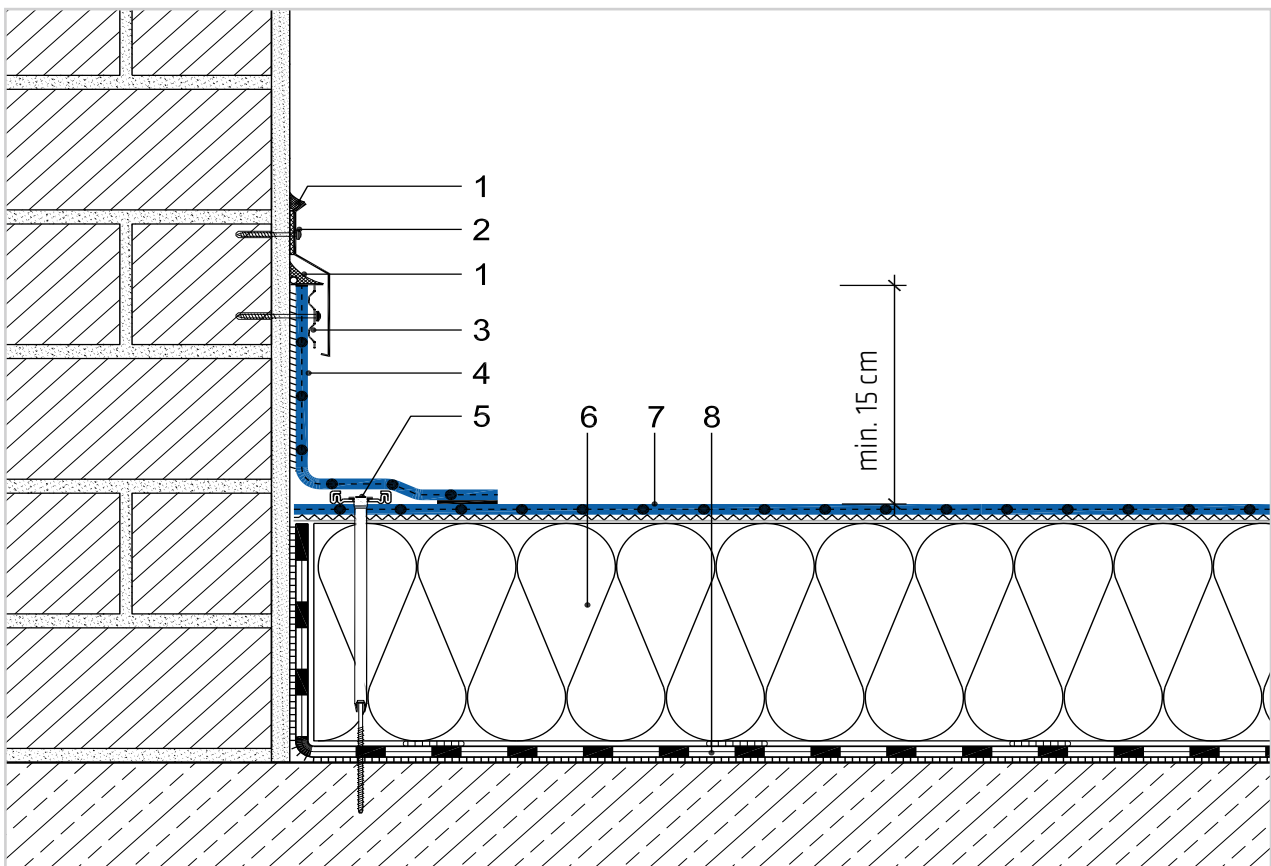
Wandanschluss ungedämmt (System Auflast)
